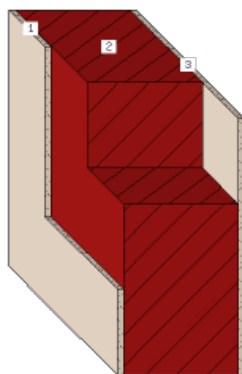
3D Schnitt durch bestehende Außenwand eines Gründerzeithauses (Autor)
